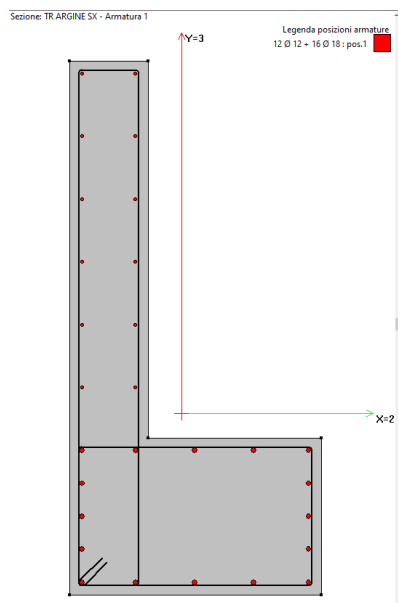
Armatura trasversale intradosso ed estradosso fondazione
